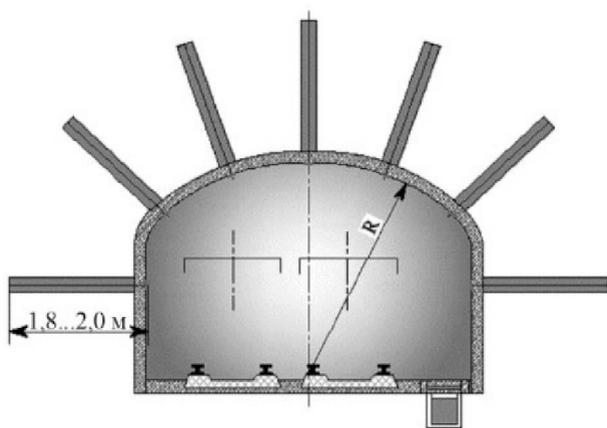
Схема сечения выработки с комбинированной анкерно-набрызг-бетонной крепью
